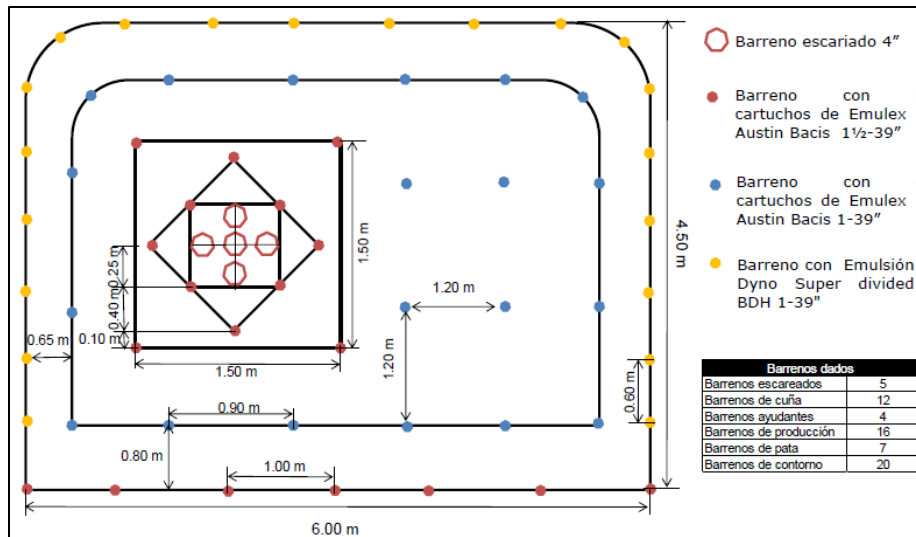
Plantilla de barrenación de sección 6.00x4.50 m con forma de cargado propuesto
